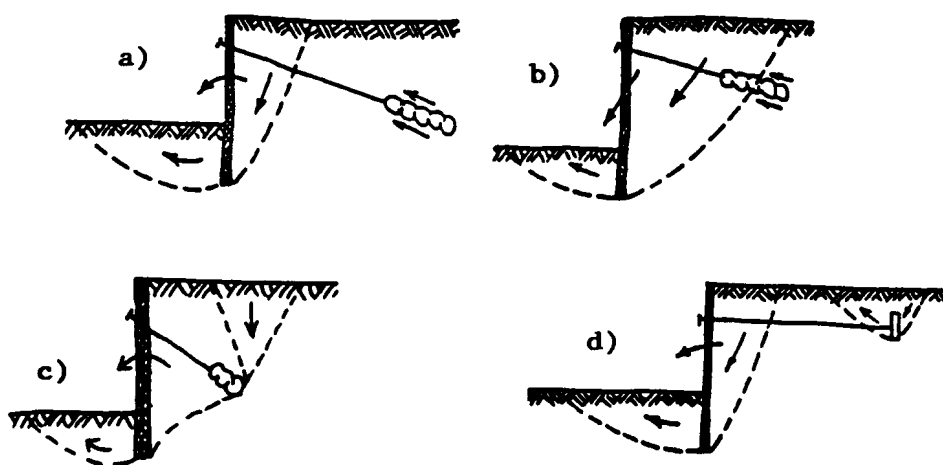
Ejemplos de situación límite para el fallo por arranque de anclajes
